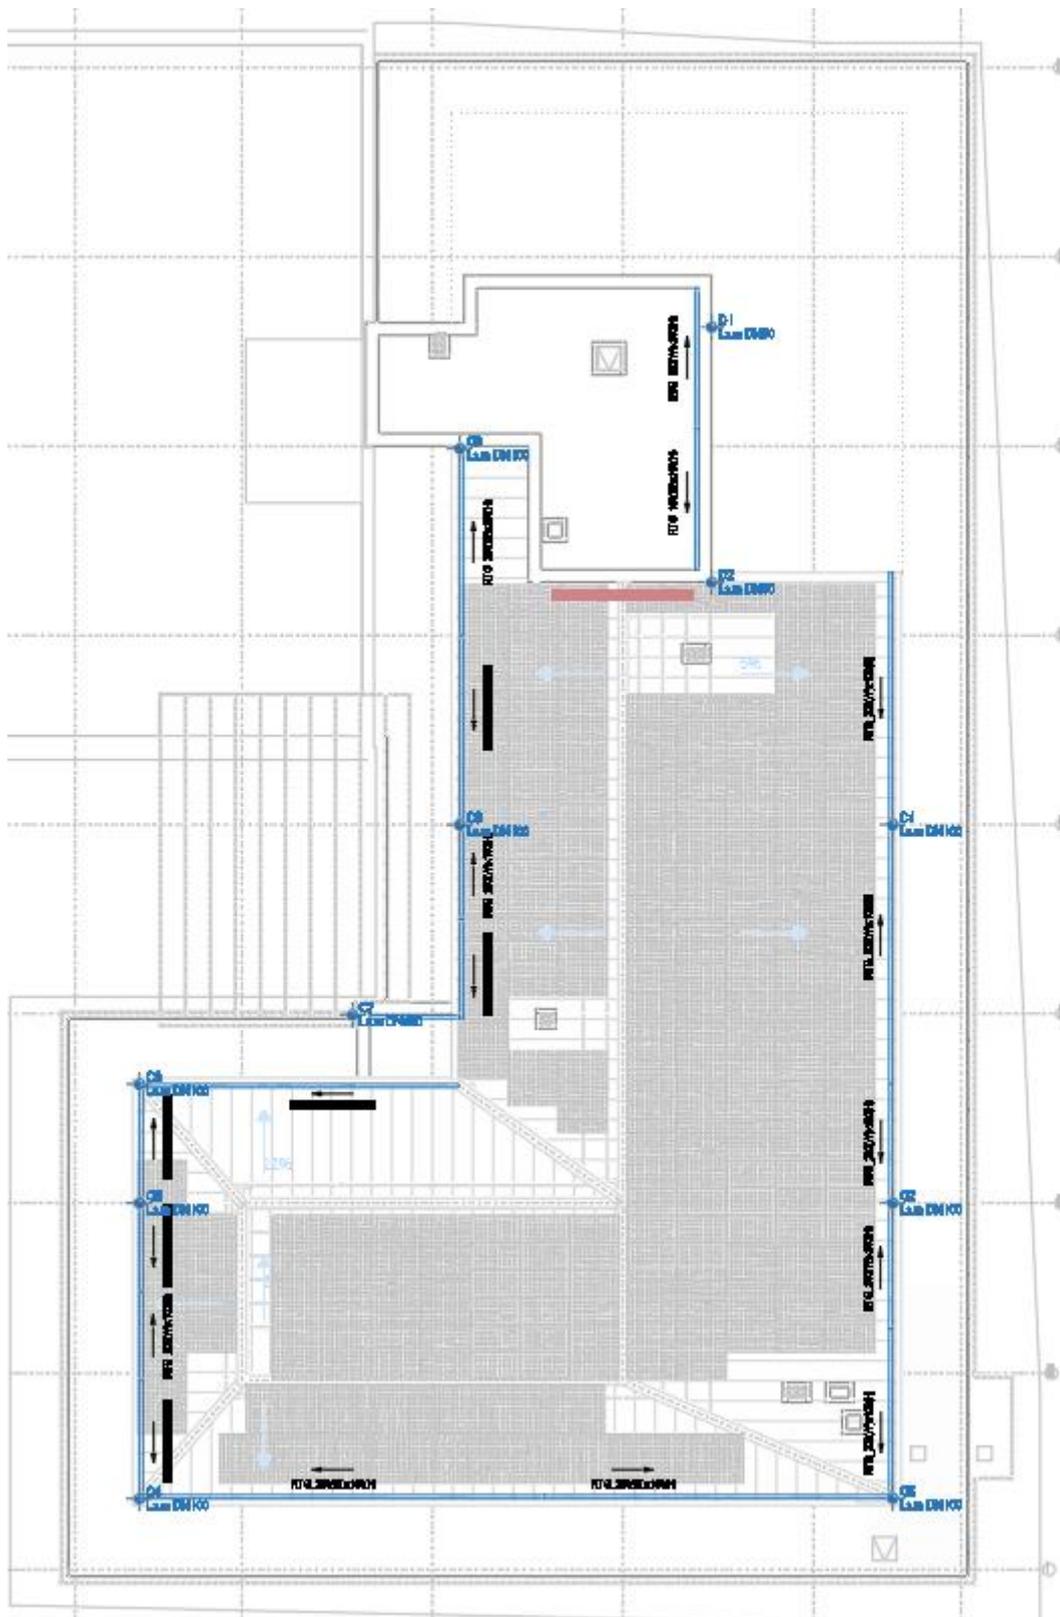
Schema della rete di raccolta al piano copertura mediante canali di gronda e pluviali
